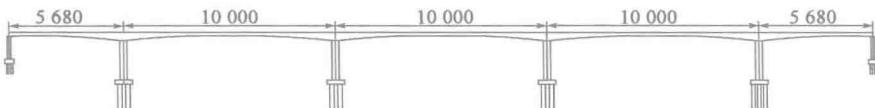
龙坊高架桥桥跨布置(尺寸单位:cm)
